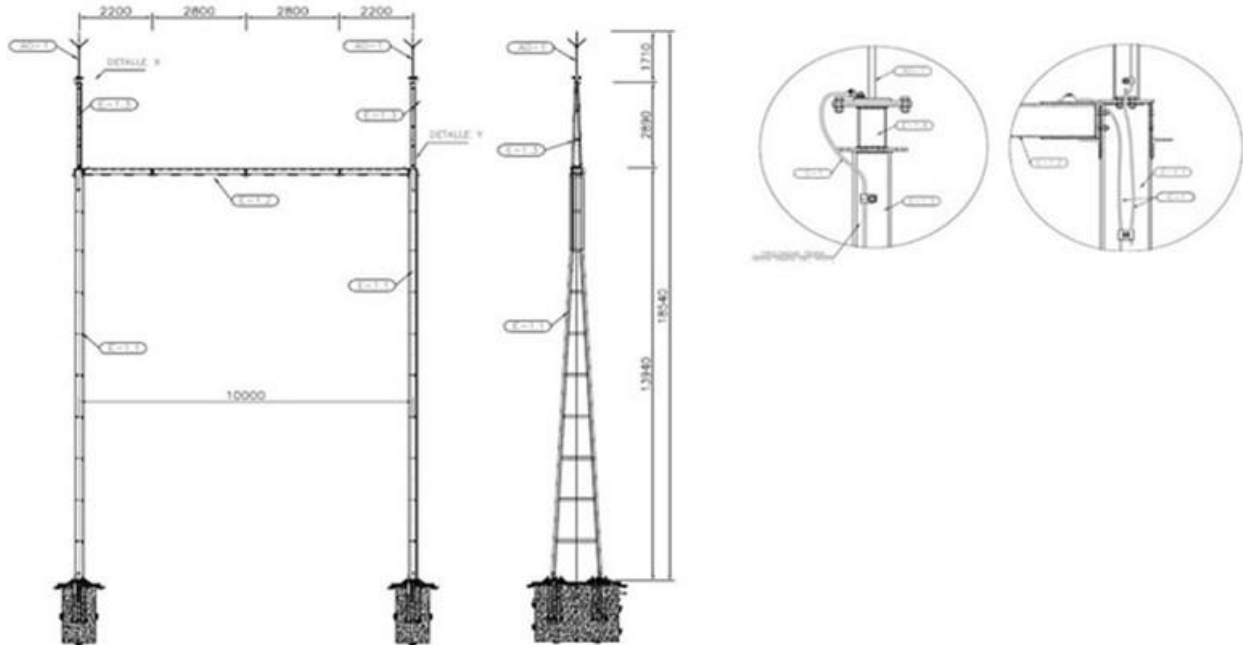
Vista lateral e frontal da estrutura do pórtico AT
